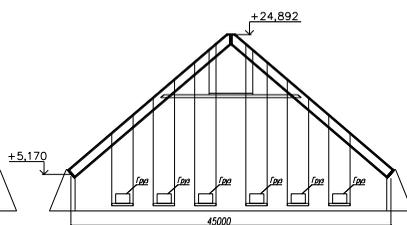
Схема испытания арок треугольного очертания нагружением бетонными блоками
